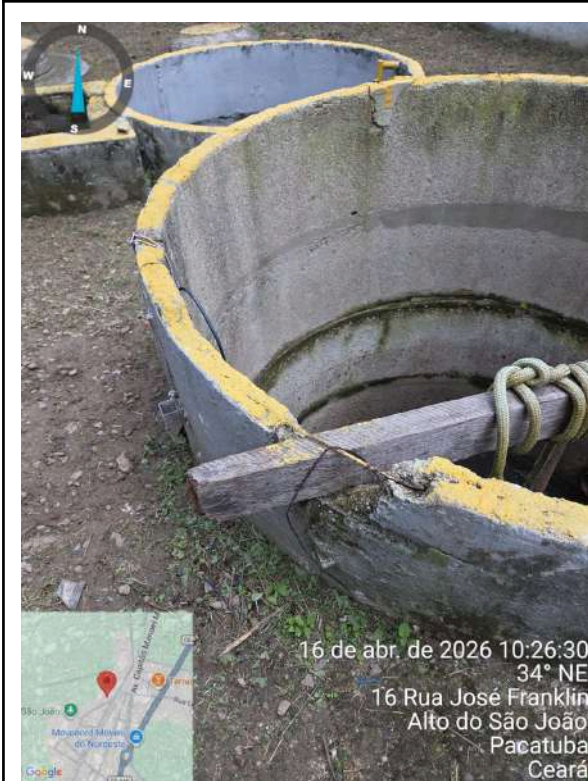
EEE-01 (Sede): poço da elevatória sem proteção, com encaixe do suporte da bomba feito improvisado.
